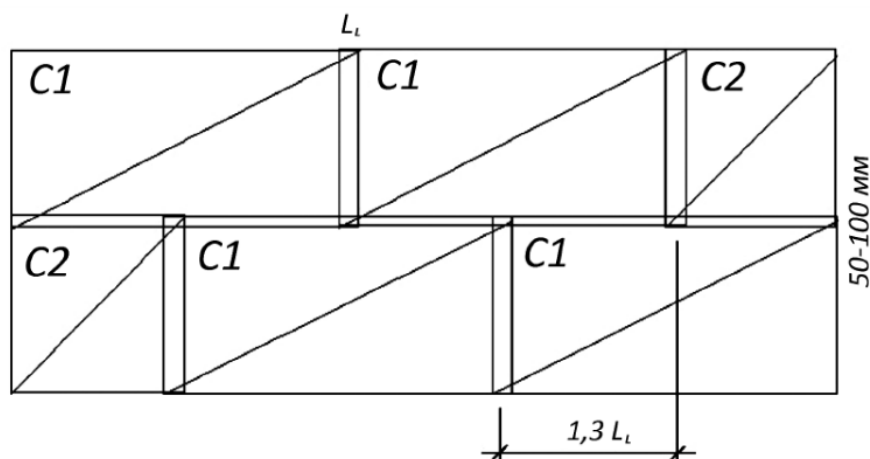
Схема стыковки арматурных сеток (перепуск рабочей арматуры – l_i , конструктивной – 50–100 мм, площадь рабочих стержней, стыкуемых в одном месте, не более 50 %)
